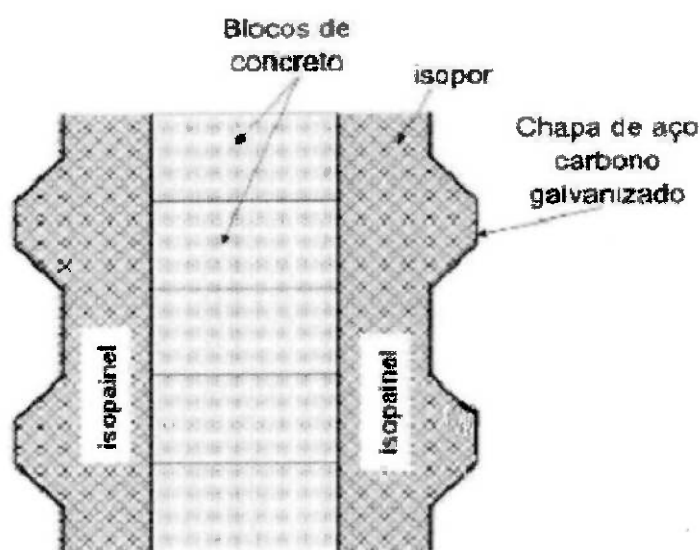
Parede tipo sanduíche composta de isopainéis e blocos de concreto
